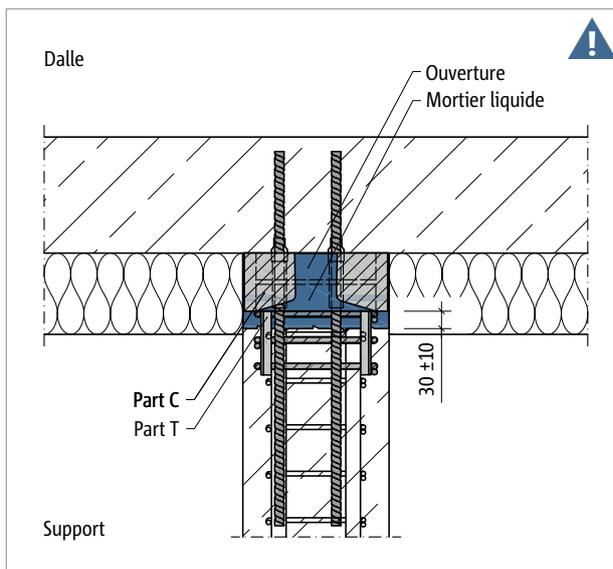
Schöck Sconnex® type P : coupe de montage ; raccordement poteau - dalle avec liaison mécanique avec le béton du poteau par le scellement en PAGEL® V1/50
